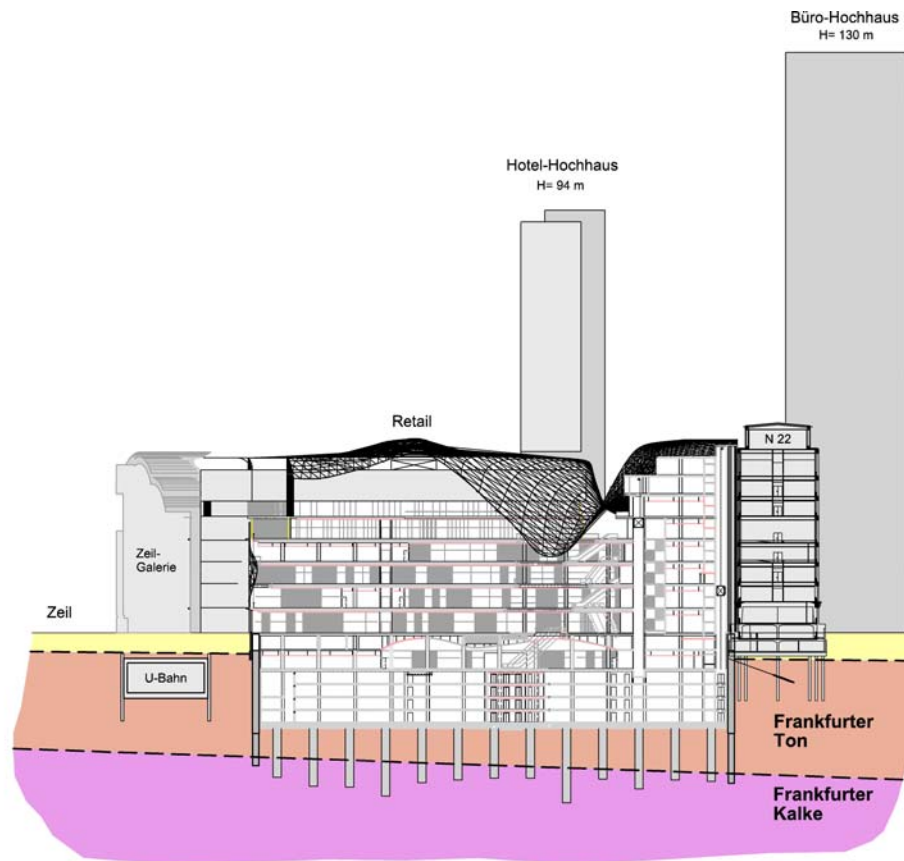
Baugrund- und Projektschnitt FrankfurtHochVier
